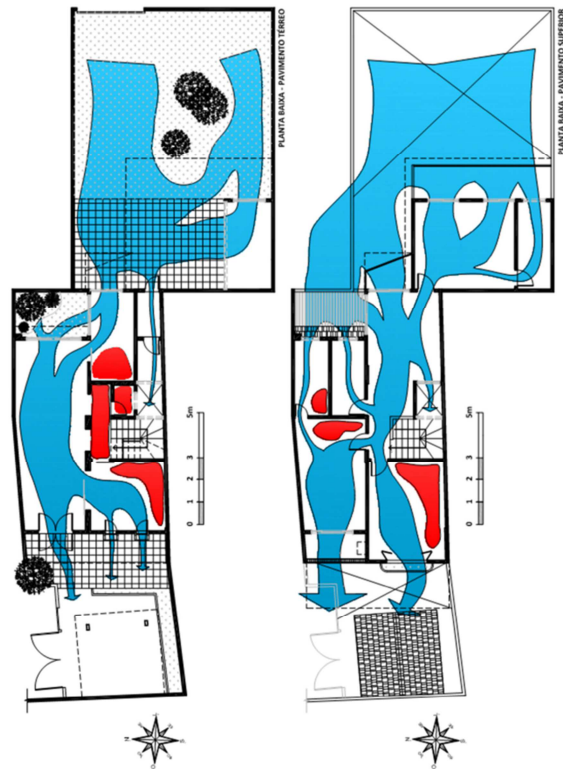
Fluxo do vento no interior da edificação – Situação proposta (Fonte: Larissa Amaral)
